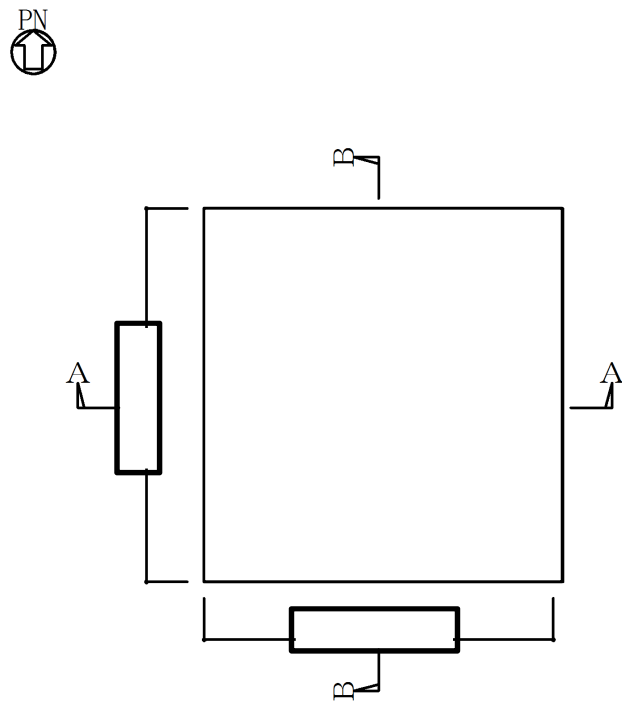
(10/10) 原子炉建屋の概略平面図 (EL. 64.08 m)
